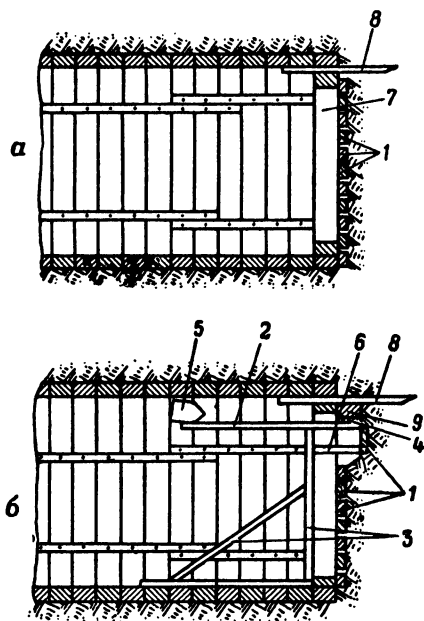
Проходка галерей с подвижным креплением из металлических полос:
